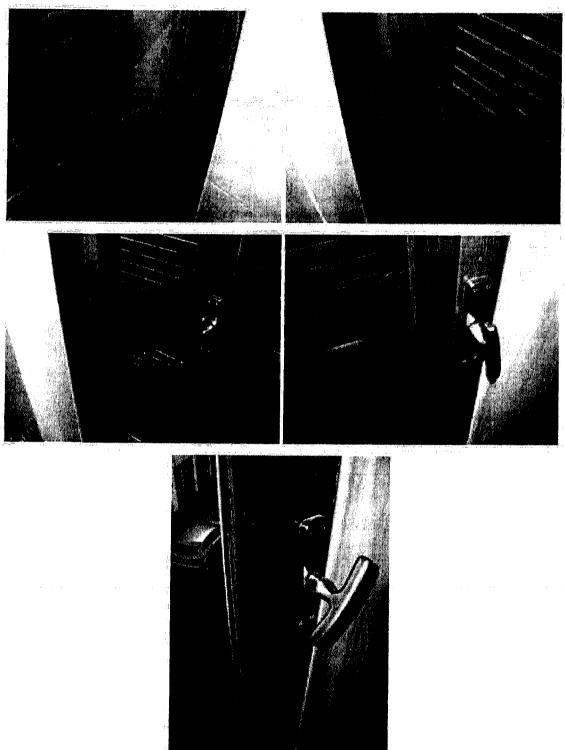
160 - Rilievo particolari – Panoramica dei serramenti finestra in legno, finitura trasparente, con vetrocamere installati al secondo piano (Sub. 3).
